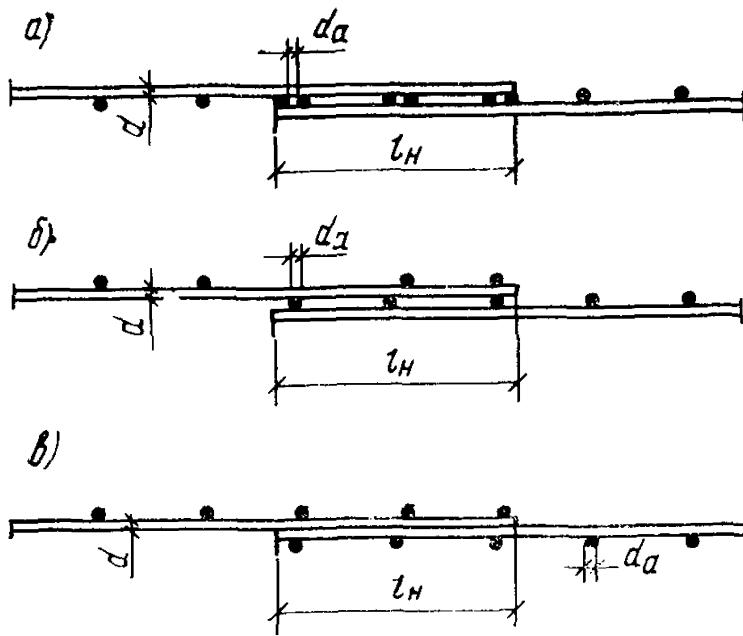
Стыки сварных сеток внахлестку (без сварки) в направлении рабочей арматуры при выполнении последней из стержней гладкой арматуры
